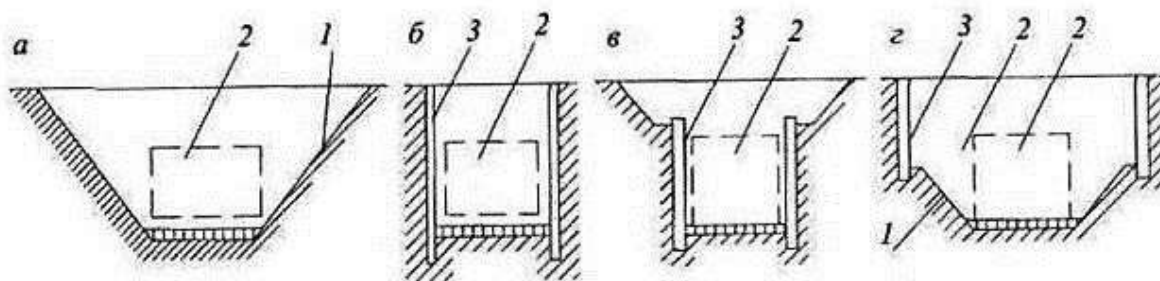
Схеми конструкції котлованів: а - з природними укосами; б - з вертикальними схилами; в, г з комбінованими схилами: 1 - укіс; 2 - підземна споруда; 3 - огорожу котловану
